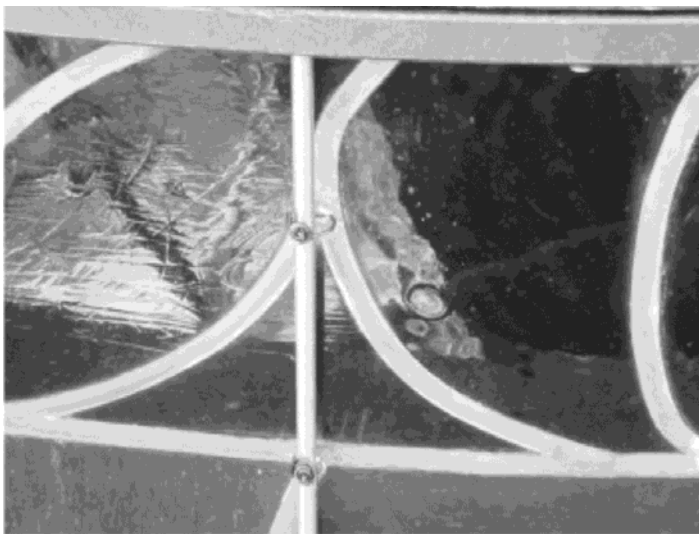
Imagen de un panel de vidriera restaurada y reinstalada, con ataduras de hilo de cobre lacado.
